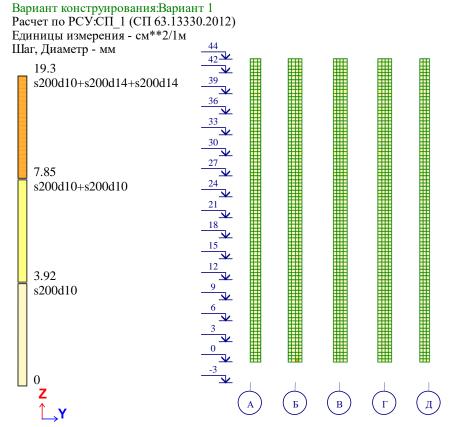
Расчетное армирование стен подвала по оси У у верхней грани.
